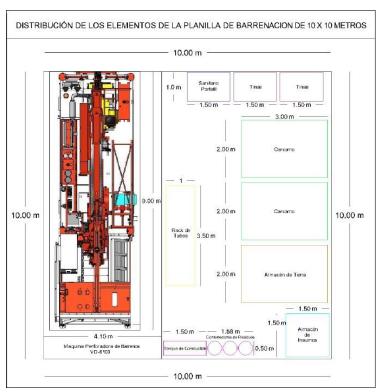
Distribución espacial de una planilla de barrenación típica de 10 x 10 m.
